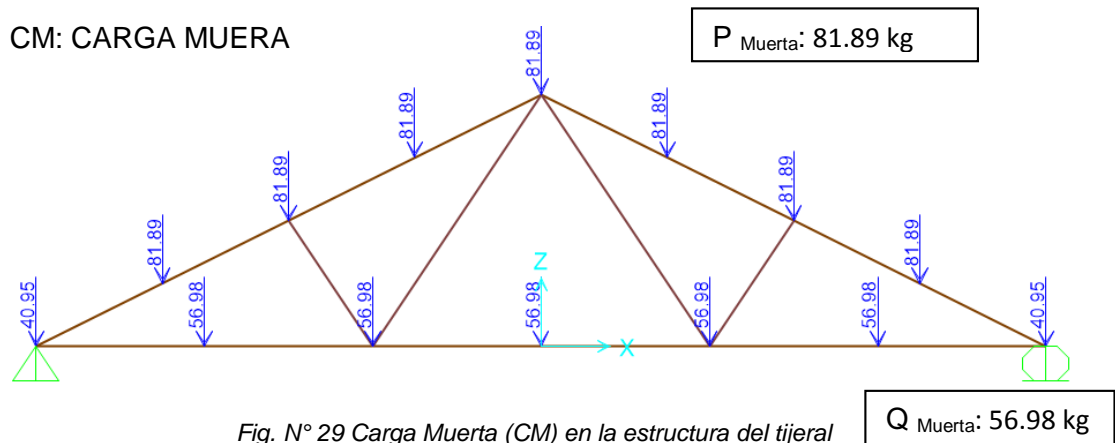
Carga Muerta (CM) en la estructura del tijeral
